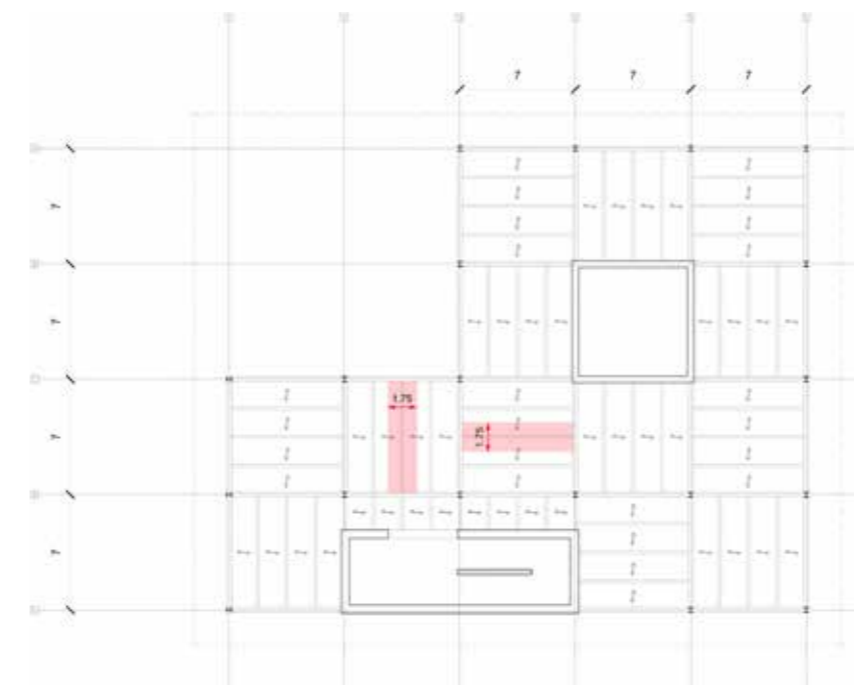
Schema strutturale trave secondaria solaio interpiano
